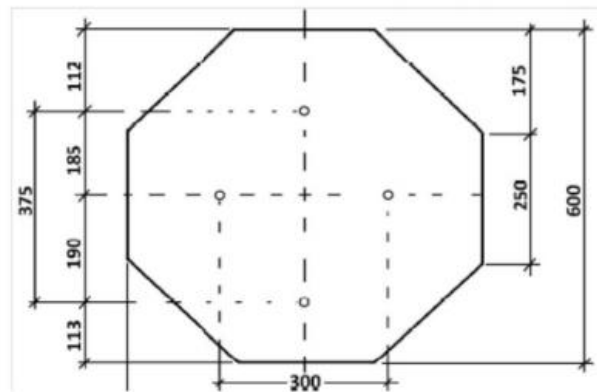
Detalhe do Dispositivo Anti-Giro e da Fundação
